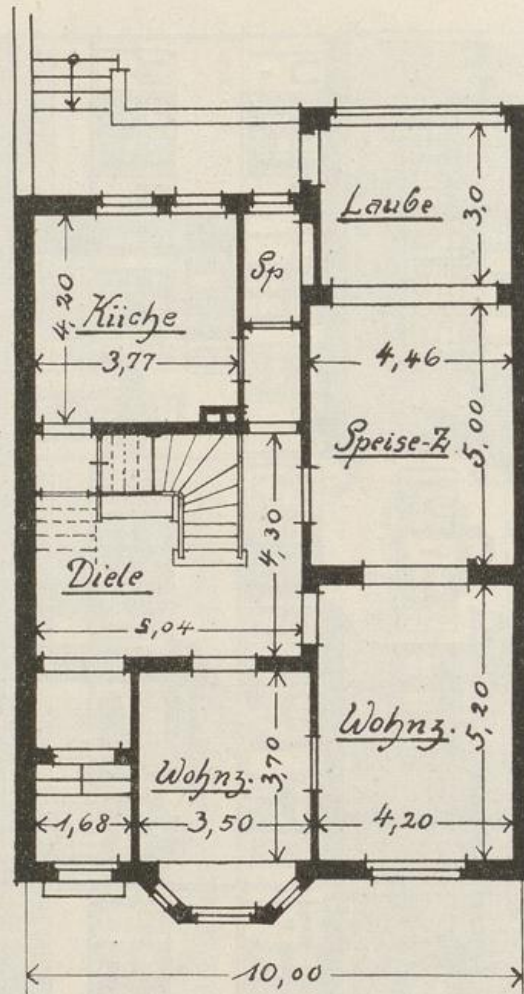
Grundriß eines eingebauten Einfamilien-Wohnhauses. Treppenhaus mit Oberlicht u. hohem Seitenlicht. Gehört zu Abb. 70.
